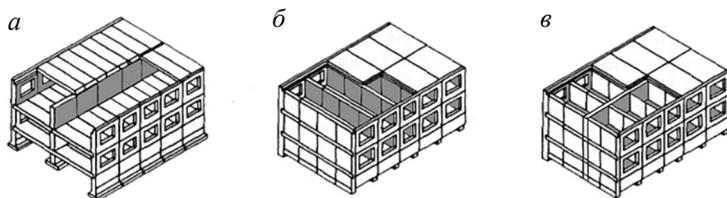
Конструктивные схемы с несущими стенами:
